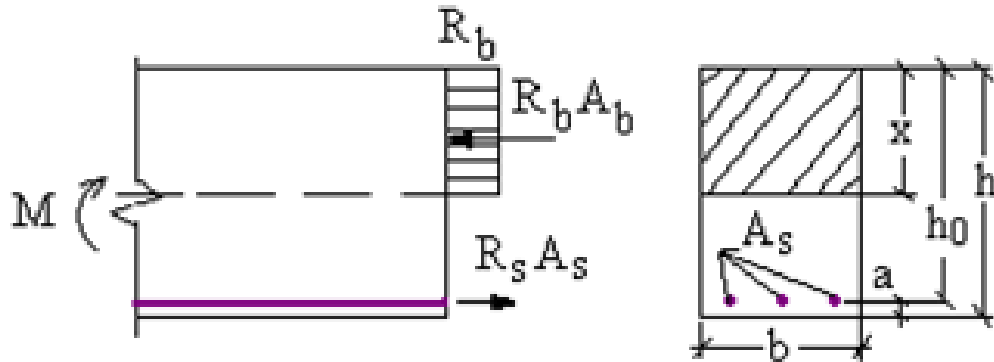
Розрахункова схема прямокутного перерізу із одиночною арматурою
